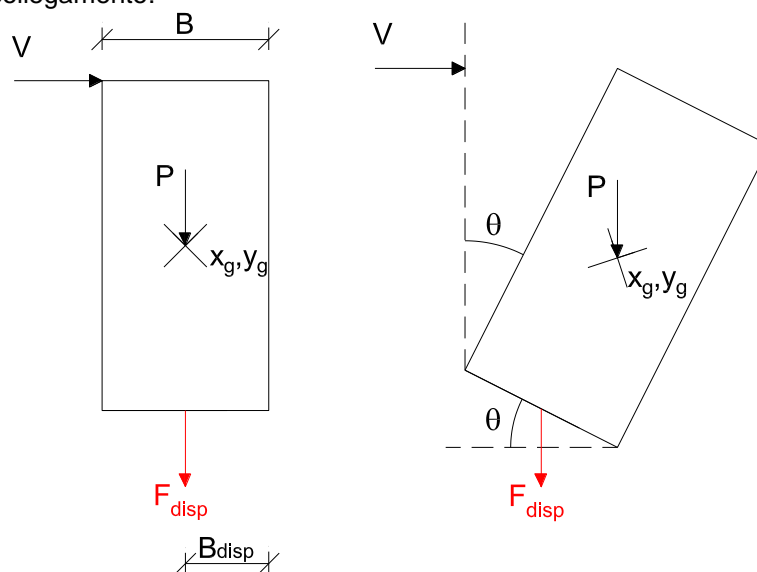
Analisi del ribaltamento nel piano ortogonale nel caso di dispositivo posizionato nella mezzzeria dell'appoggio trave-pilastro.
